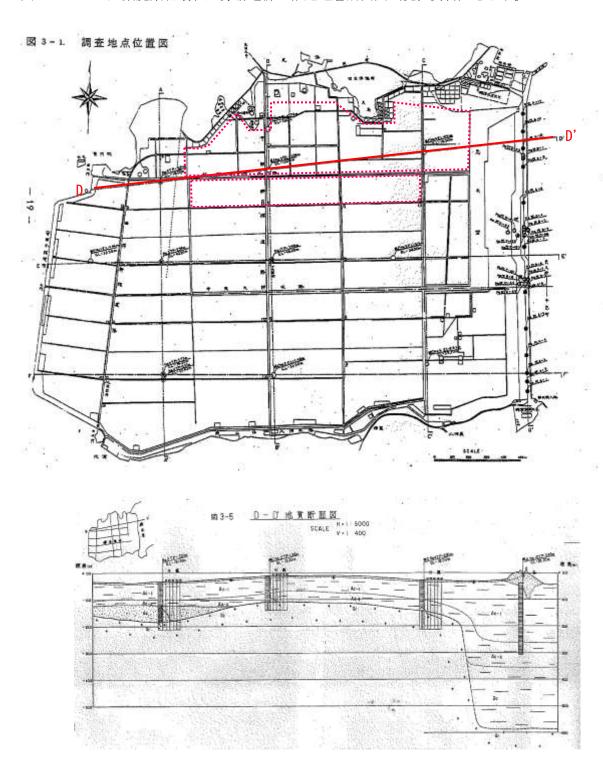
産業廃棄物最終処分場付近の地層断面図
